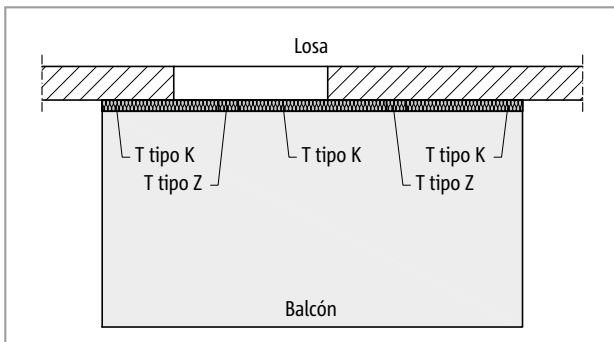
Schöck Isokorb® T tipo Z, K: Balcón en voladizo
